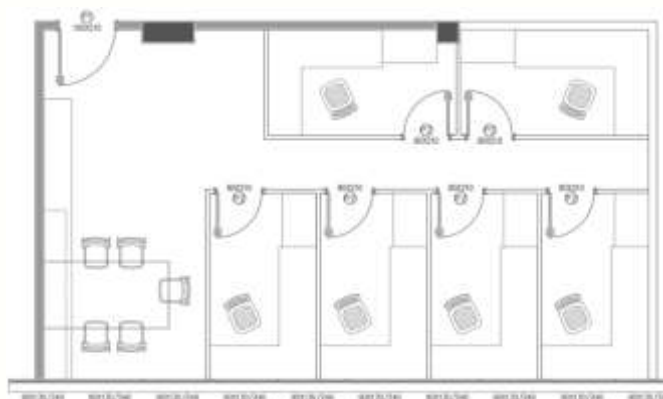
Planta baixa do projeto. Fonte: Acervo do EMAU Perspectiva.
